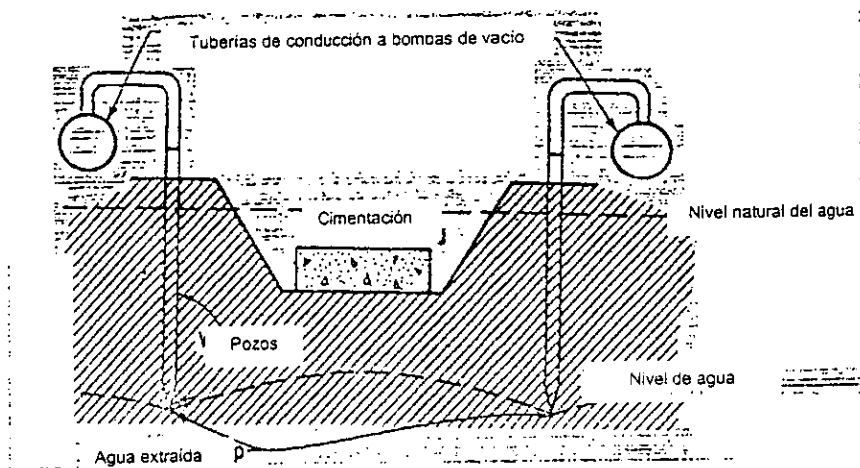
Los pozos de extracción abaten el nivel freático hasta que se construye el desplante de la cimentación
